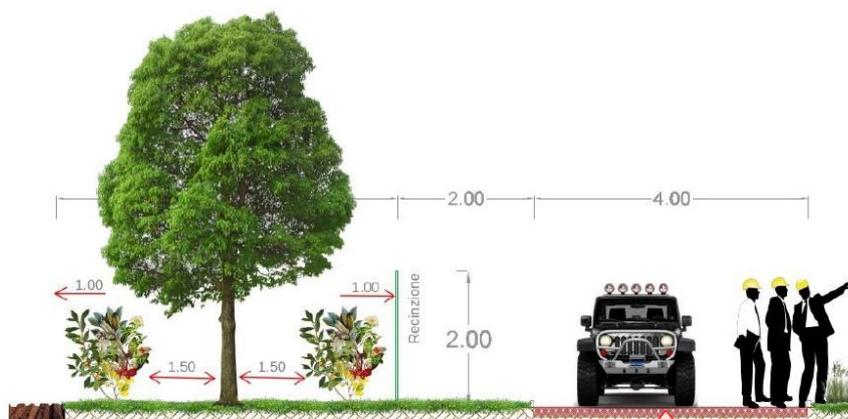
Sezione tipo della fascia tampone perimetrale
